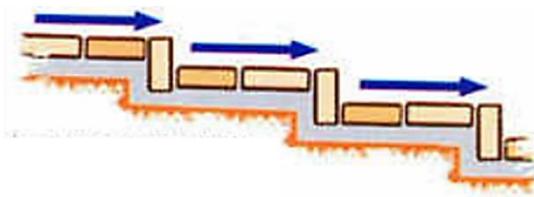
pose de pierre verticalement sur les bordures. Établir par les étudiants.
